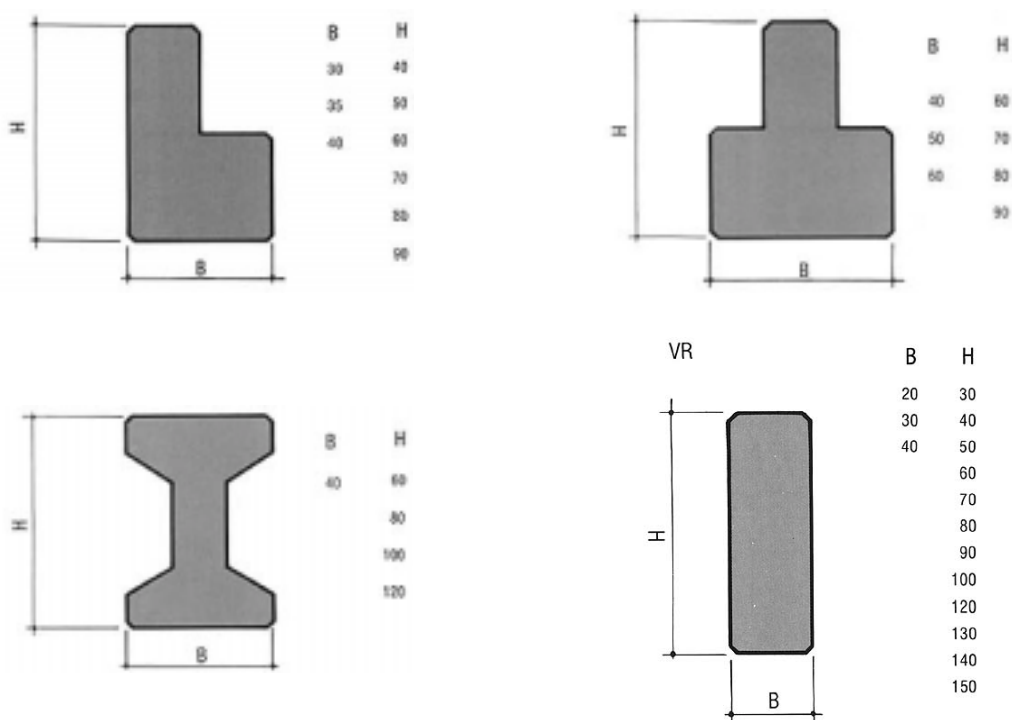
Seções típicas de vigas pré-moldadas protendidas (*Cortesia PRECON*)
